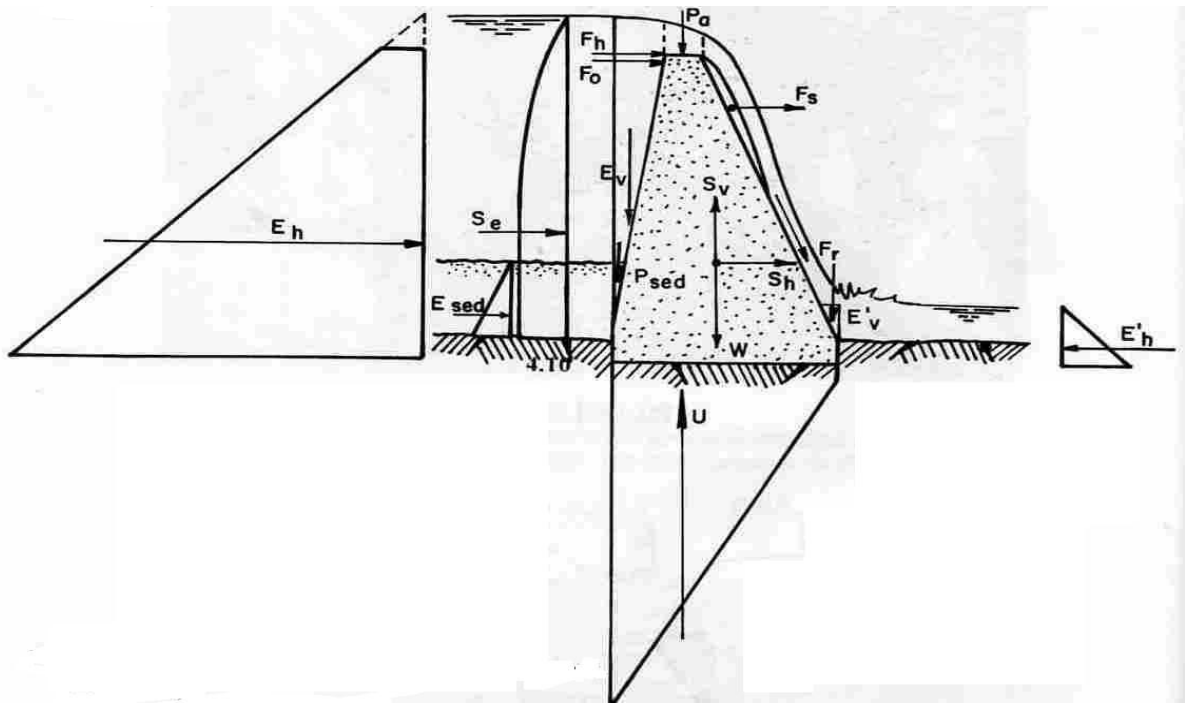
Fuerzas actuantes en una presa de gravedad. (Suárez, 1993).
